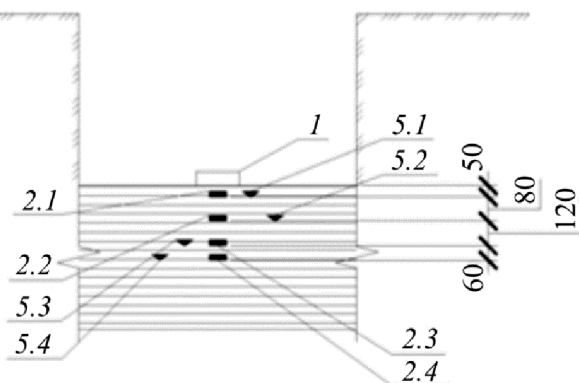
Схема испытаний № 1. Неулучшенный грунт основания: 1 – жесткий штамп; 2 – грунтовые месдозы (2.1–2.4 – номера месдоз); 5 – грунтовые марки (5.1–5.4 – номера марок)
